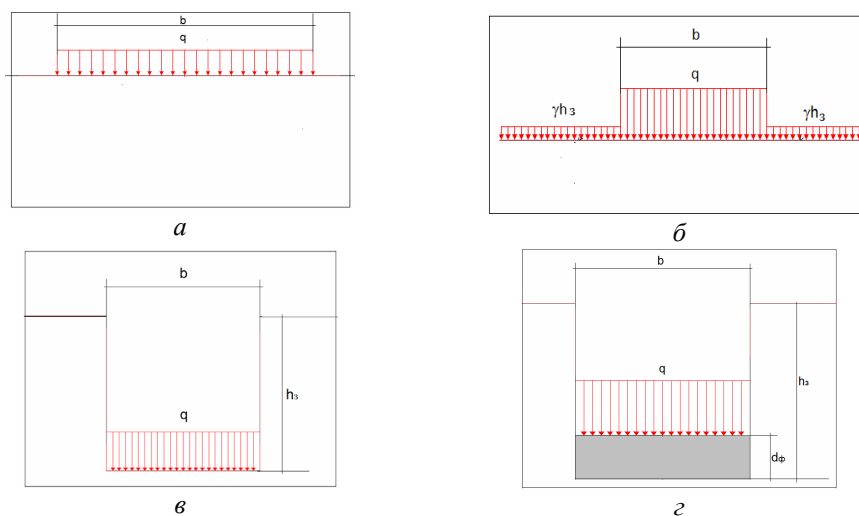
Фрагменты расчетных схем основания ленточного фундамента
